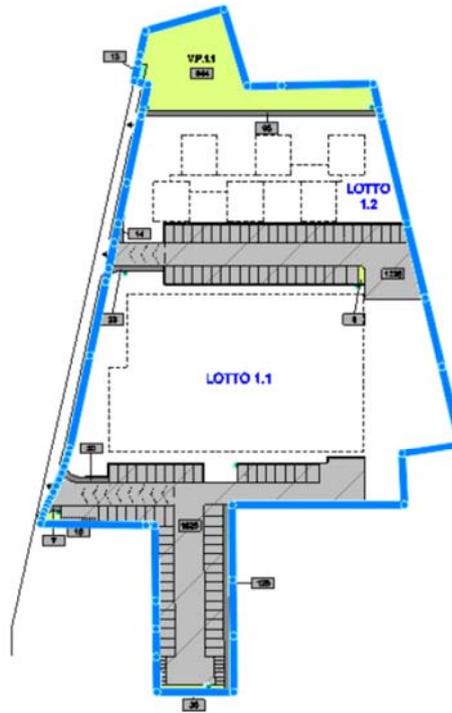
Planimetria dell'intervento con individuazione del bacino di scolo.
